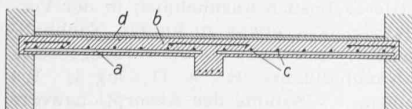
Eisenbetondecke mit Heizrohren als Armierung
